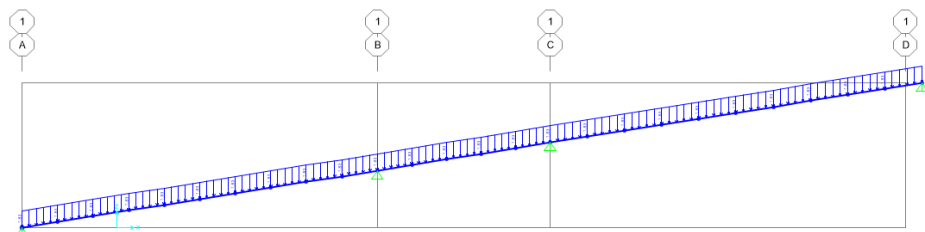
Aplicación de las cargas rampa acceso semisótano.
